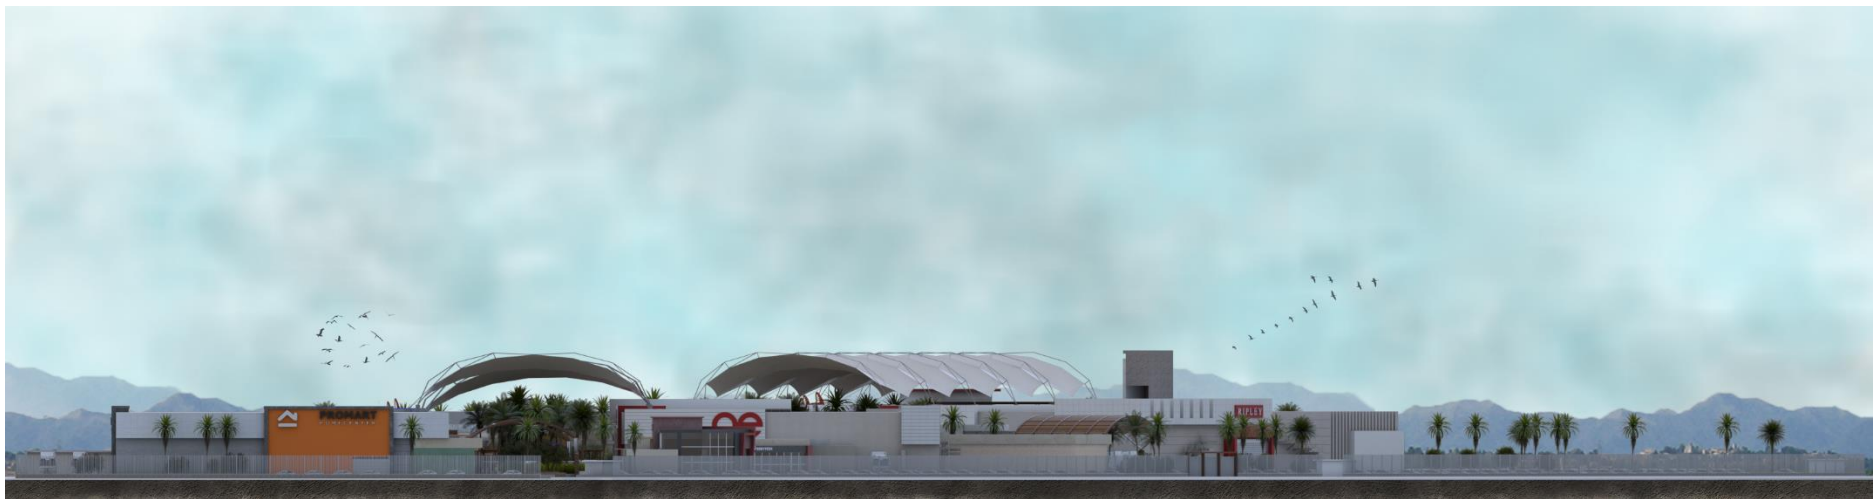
Fachada Posterior- Av. Los Cedros
